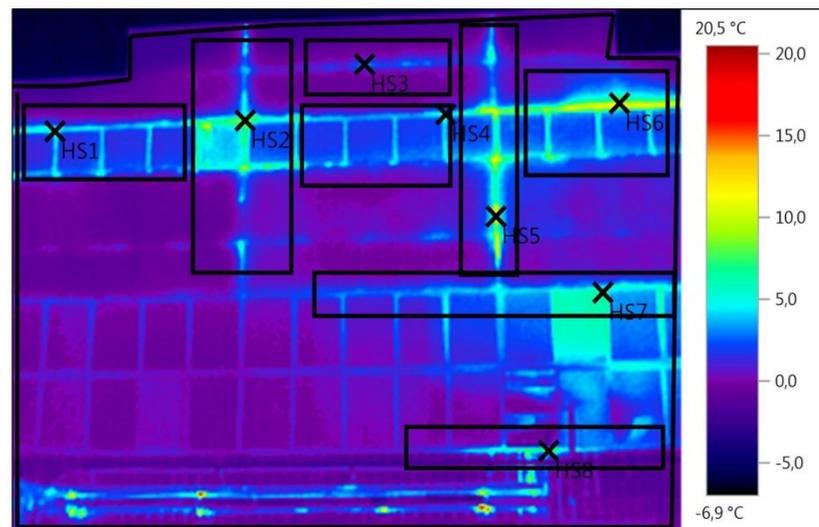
Тепловизионное обследование стены, выявившее дефекты теплоизоляции.
